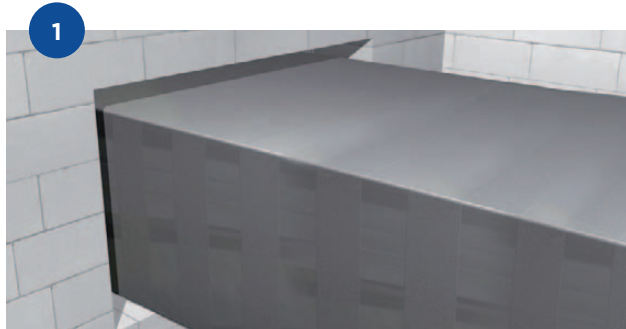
Rozmístění trnů a vrutů Fire Screw u přidavné druhé vrstvy izolace
